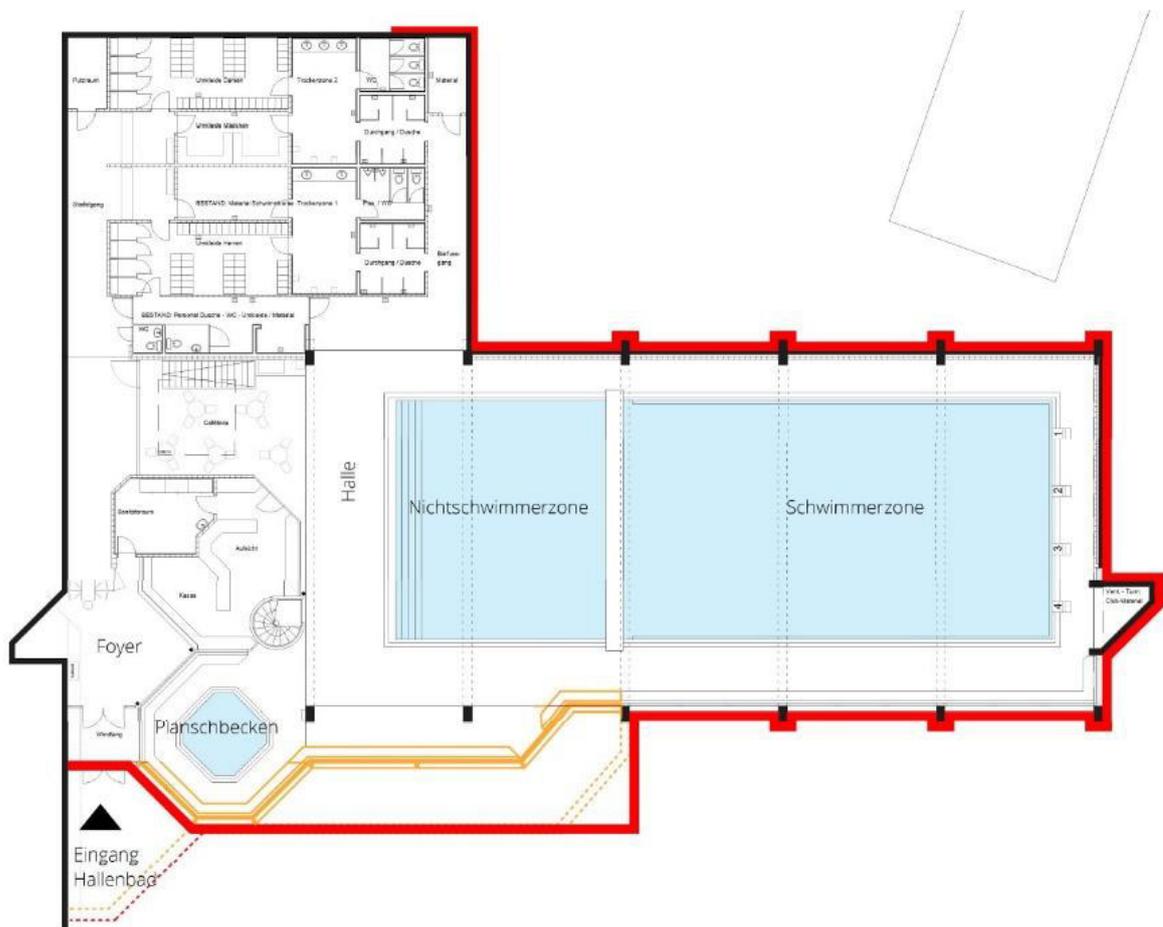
Prinzipplan Fassadensanierung und Hallenvergrösserung
